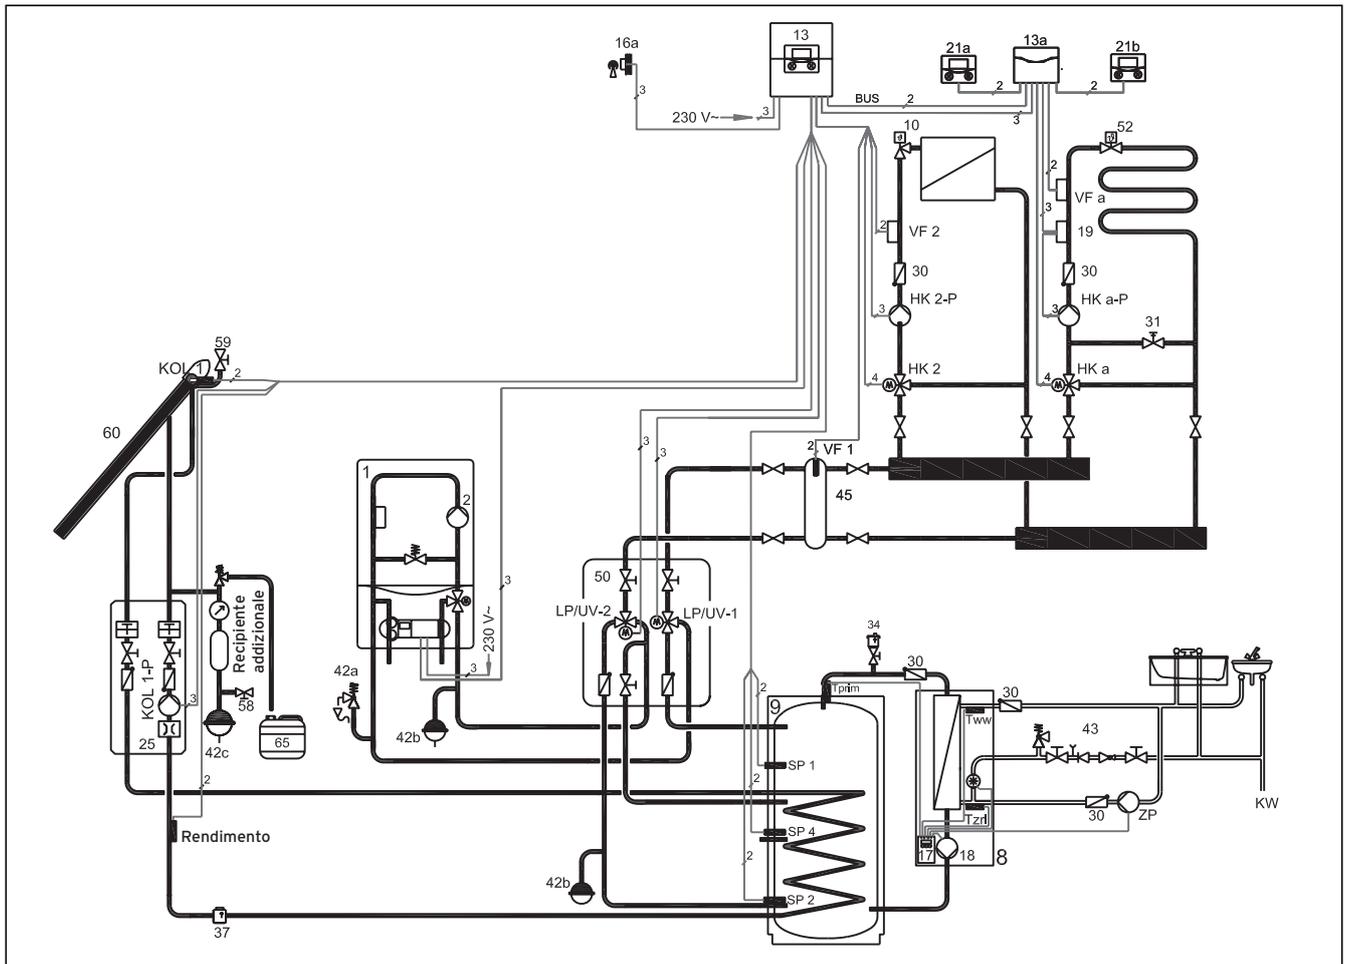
Schema di collegamento serbatoio di accumulo con integrazione solare al riscaldamento
